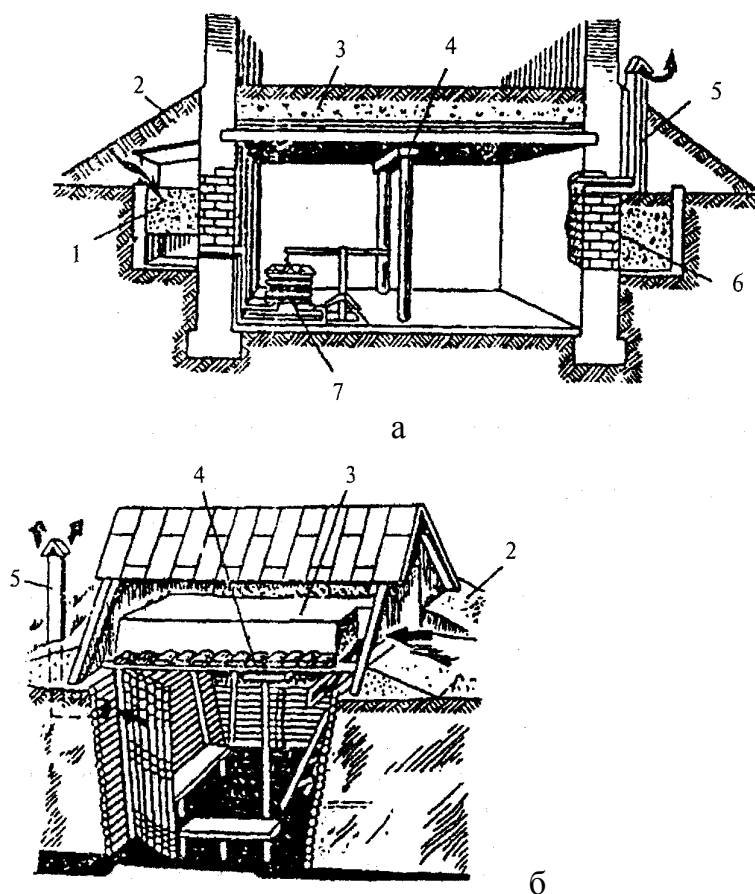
Оборудование подвального помещения (а) и погреба (б) под противорадиационное укрытие: 1 - фильтр-поглотитель; 2 - грунтовая обсыпка; 3 - слой грунта на перекрытии; 4 - усилительная подпорка; 5 - вытяжной короб; 6 - кирпичная заделка оконного проема; 7 - вентилятор (мехи).
